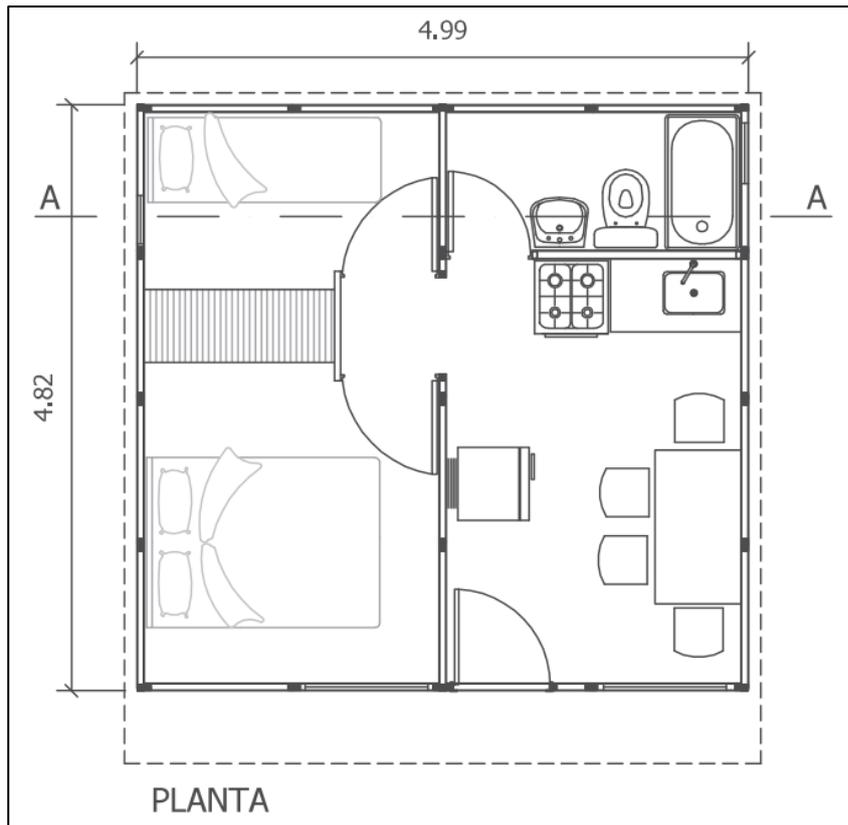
vista en planta del módulo de emergencia (planteada en la investigación)
